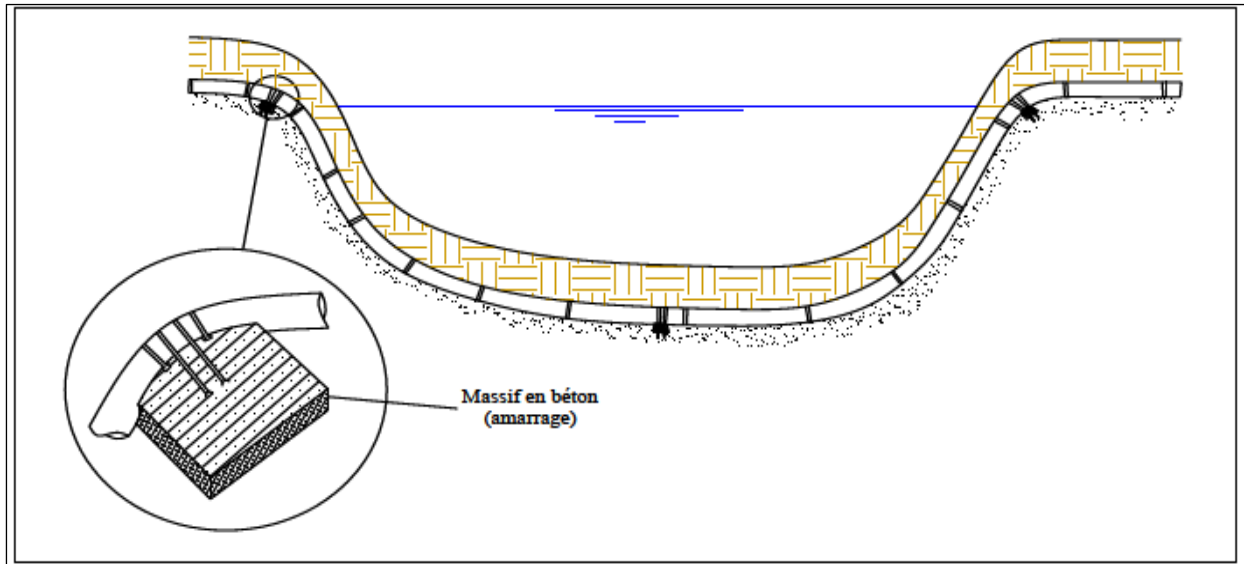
Pose de canalisation à la traversée d'une rivière.
